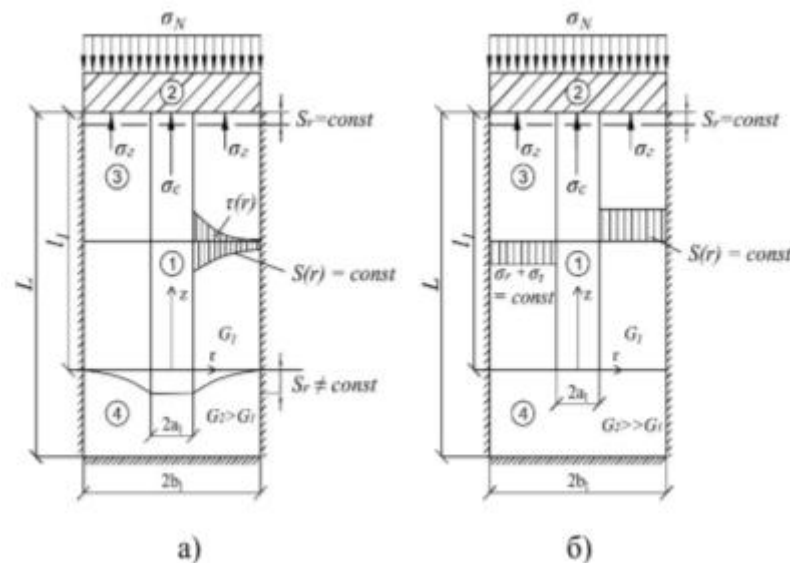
Розрахункова схема взаємодії палі у складі пальново-плитного фундаменту з обмежуючим і підстилаючим ґрунтами та розтверком за схемою:
